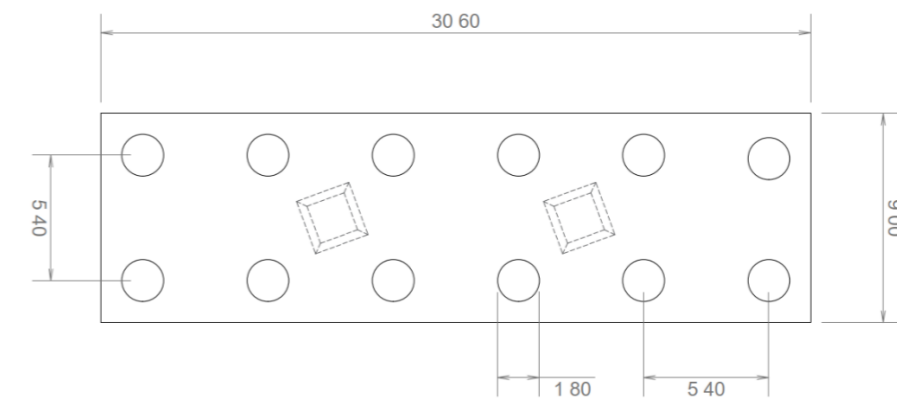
Vista en planta de los encepados y pilas (fuente: elaboración propia)
